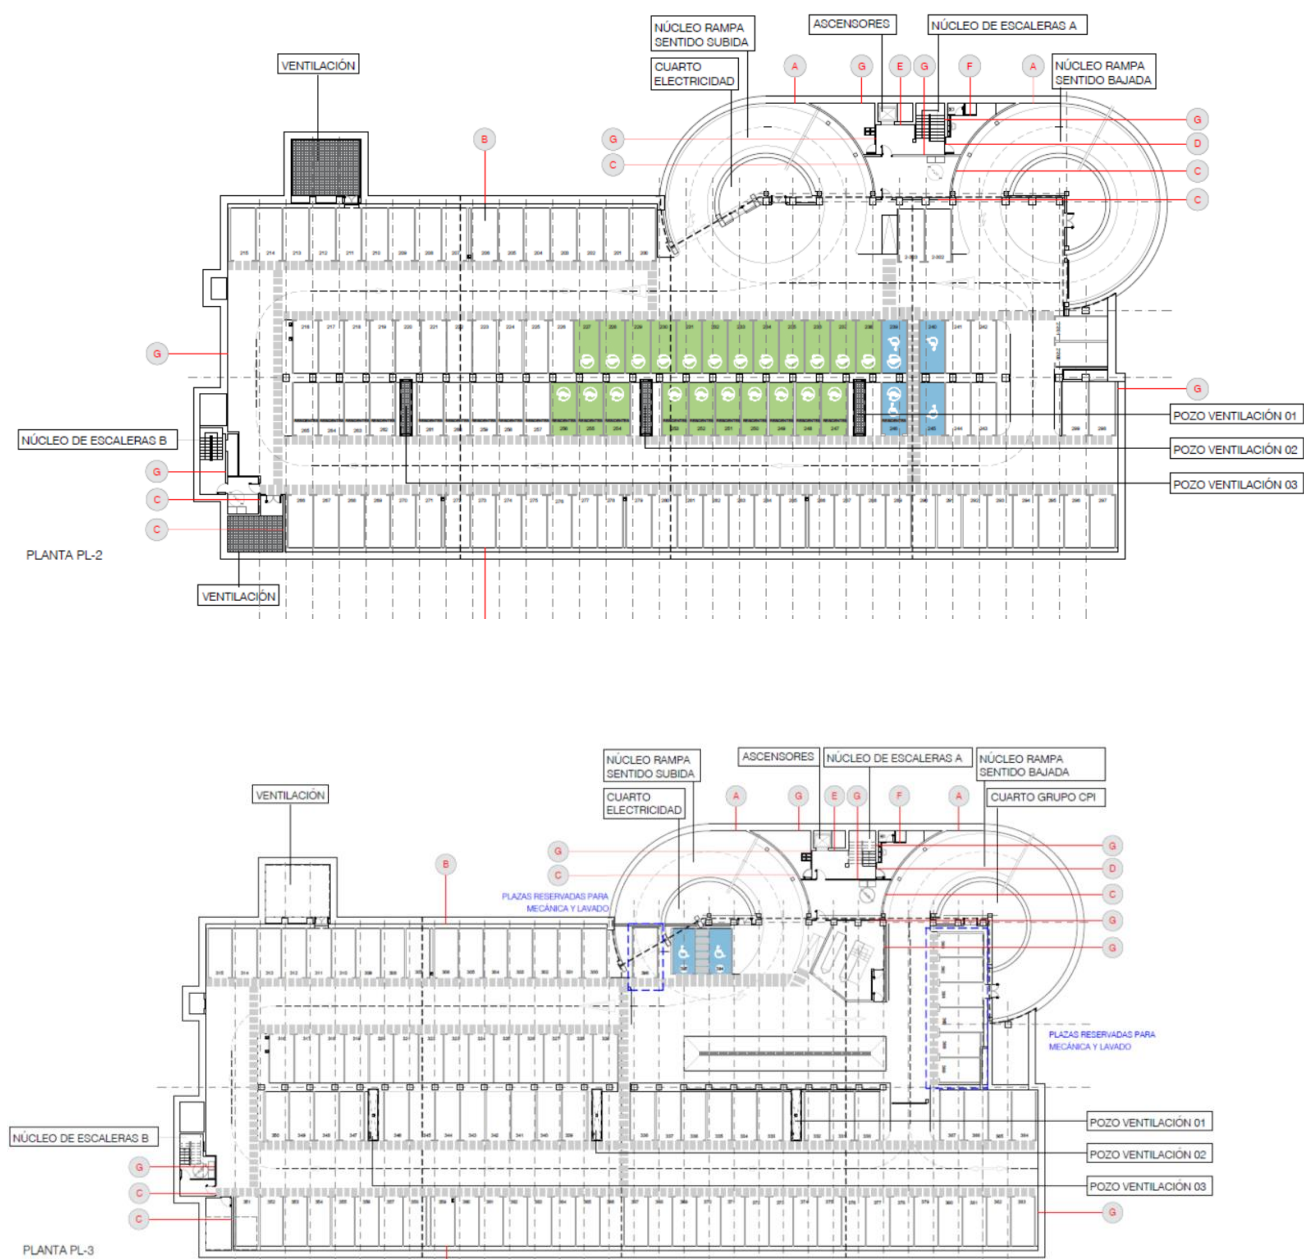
Resumen de la propuesta de distribución de las plantas sótano
